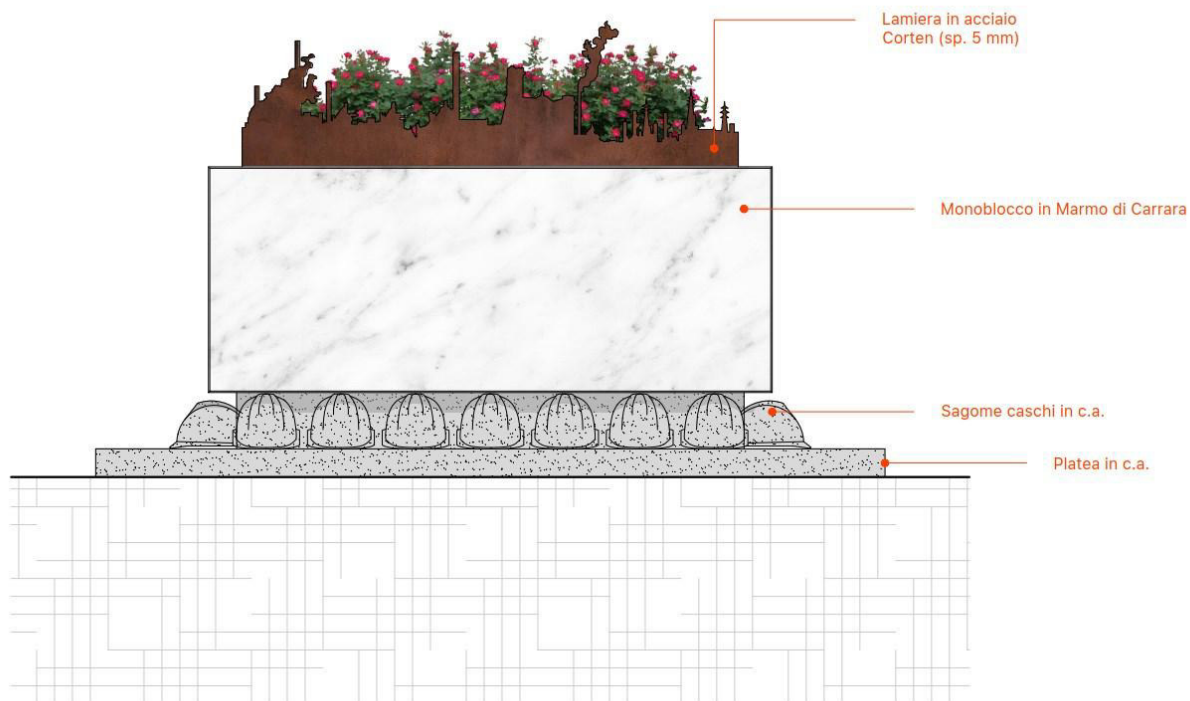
| Prospetto EST/OVEST – Indicazione dei materiali utilizzati in progetto
